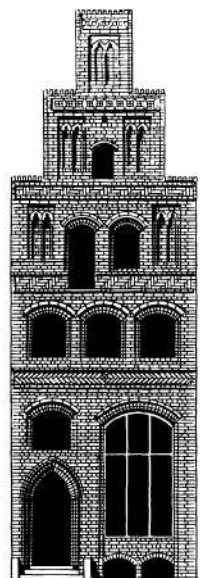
Люнебург, позднеготический жилой дом, кирпич с фантастической перевязкой. На нижнем этаже высокий зал, над ним один жилой и 2 мансардных этажа, типичные лучковые окна и ступенчатый фронтон
